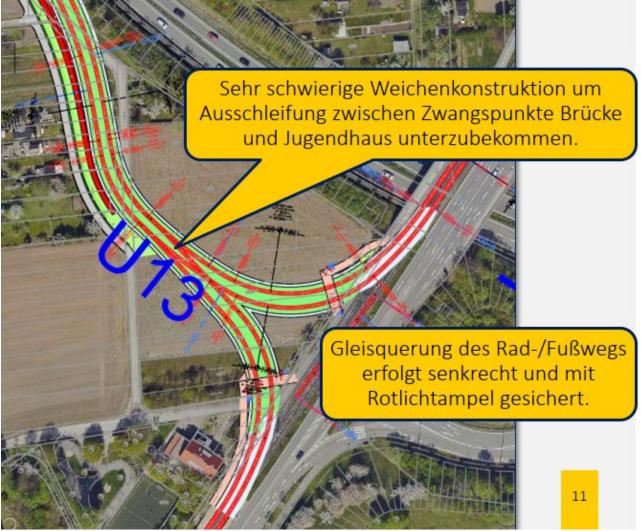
Lageplan Ausschleifung U13 aus Bestandsstrecke
